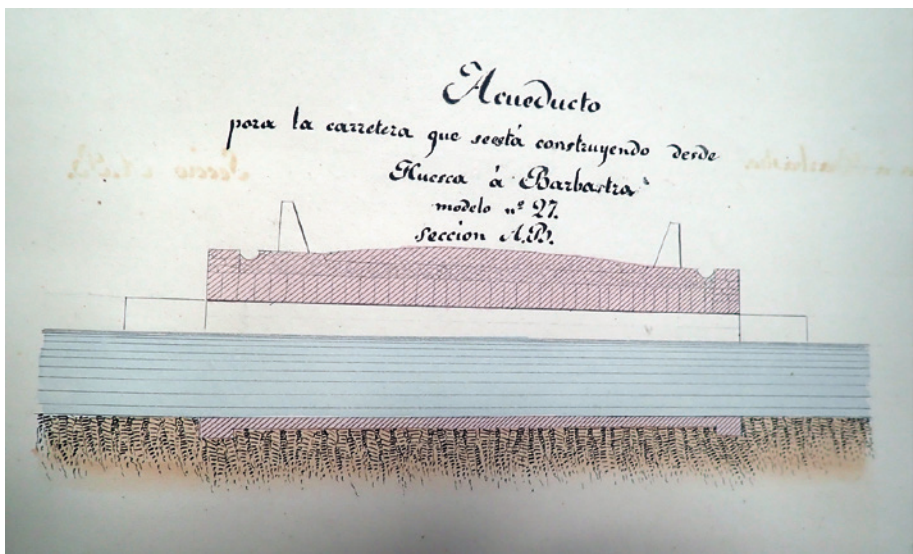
Detalle de obra: paso de la carretera entre Huesca y Barbastro.
